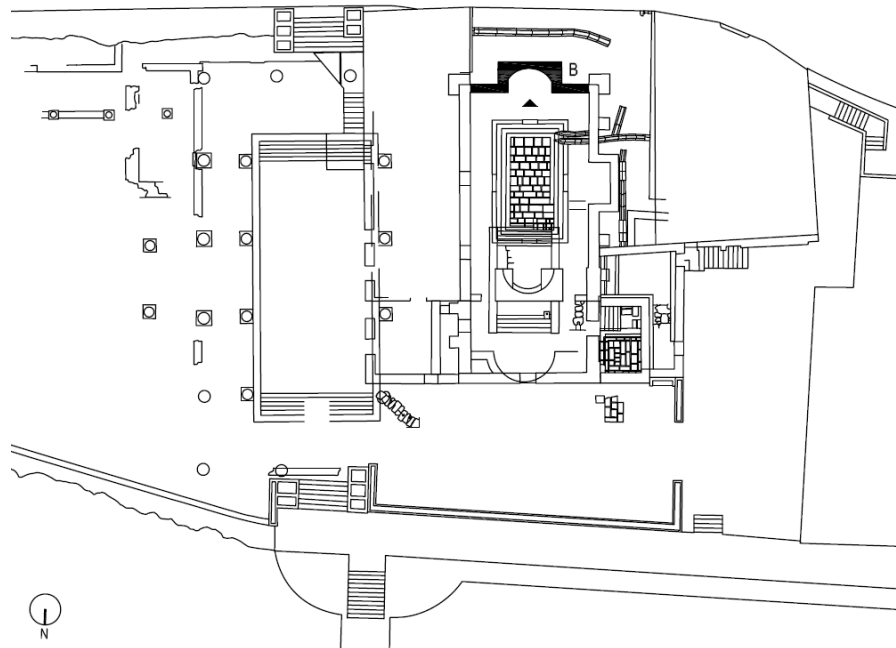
Planta e Interior da parede B, a sul (Frade, 2000).
